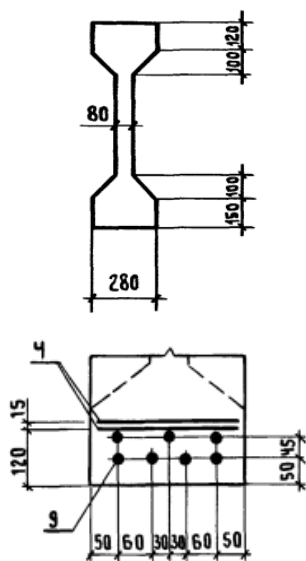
Железобетонная балка покрытия здания котельной на поперечном разрезе с указанием мест коррозии стальной арматуры в нижней грани (рисунок авторов)
